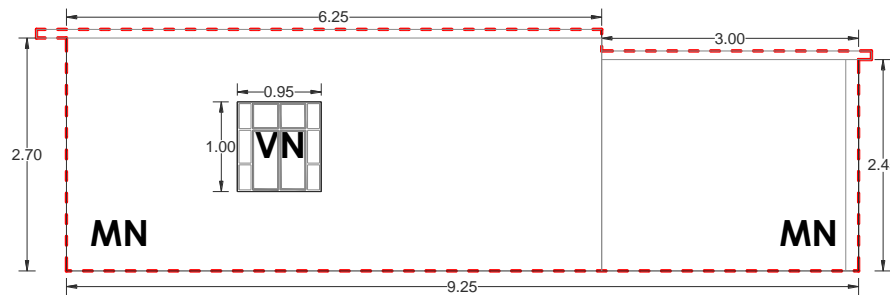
Fachada Norte – F2. Fuente: Elaboración propia.
